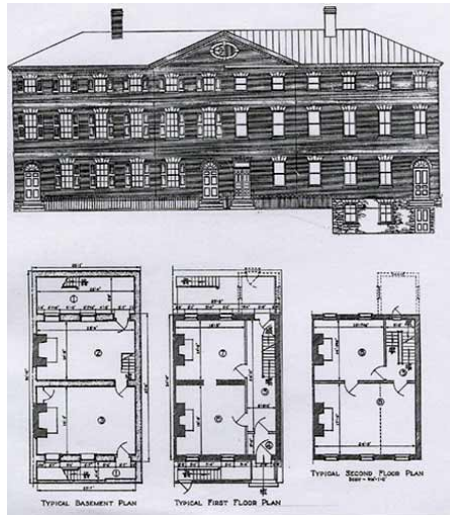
Plan de la Wheat Row, construite en 1794 par William Loring à Washington D.C. (archives Historic American Building Survey, Library of Congress, Washington D.C.).
